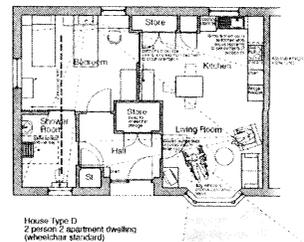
ハノーバー住宅協会の提供する一般的な住宅の平面図 (ハノーバー住宅協会パンフレットより)
